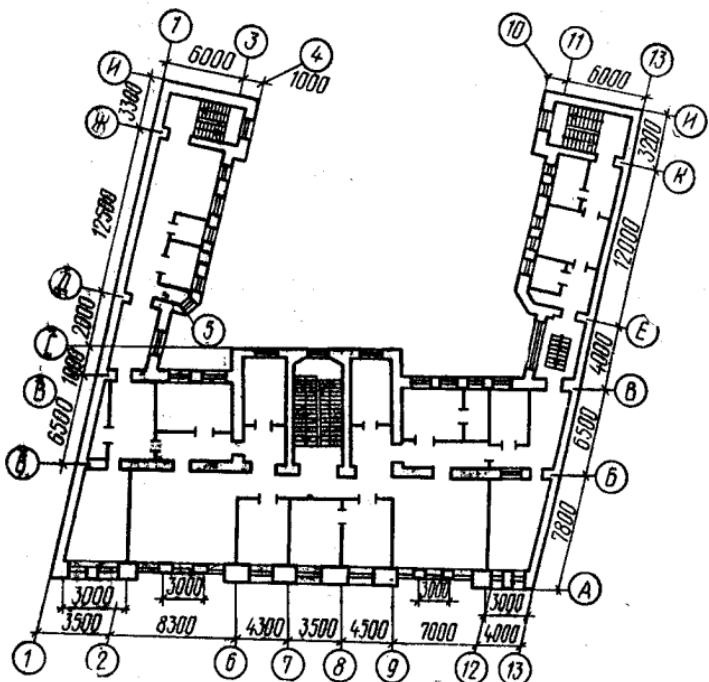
План типового этажа реконструируемого жилого дома (г. Харьков)
